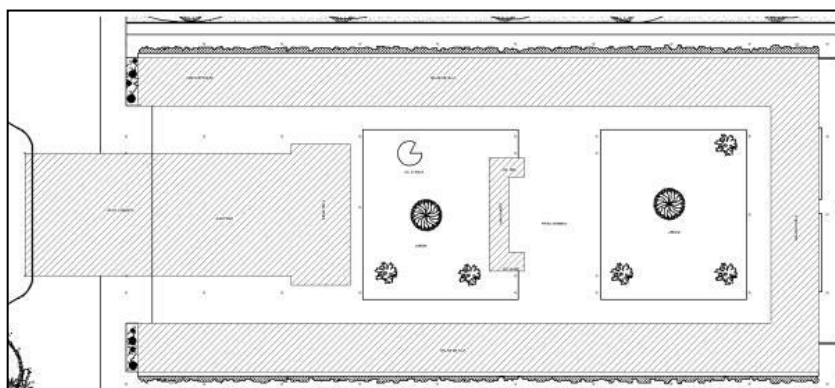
Planta Baixa do Bloco Central de Vilanova Artigas para a Escola Tiradentes; Fonte: SEINF, 2001.
